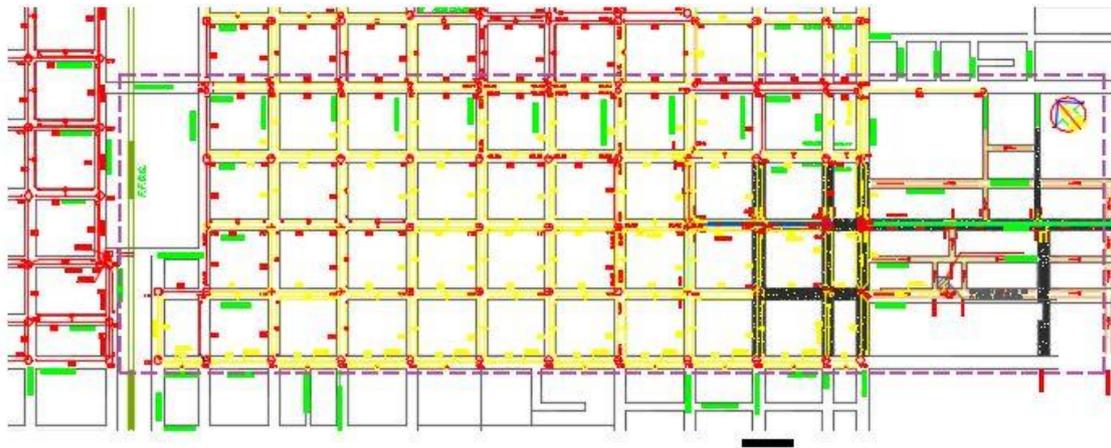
Proyecto de cloacas y de pavimentos superpuestos. Fuente: Estudio de Ingeniería
